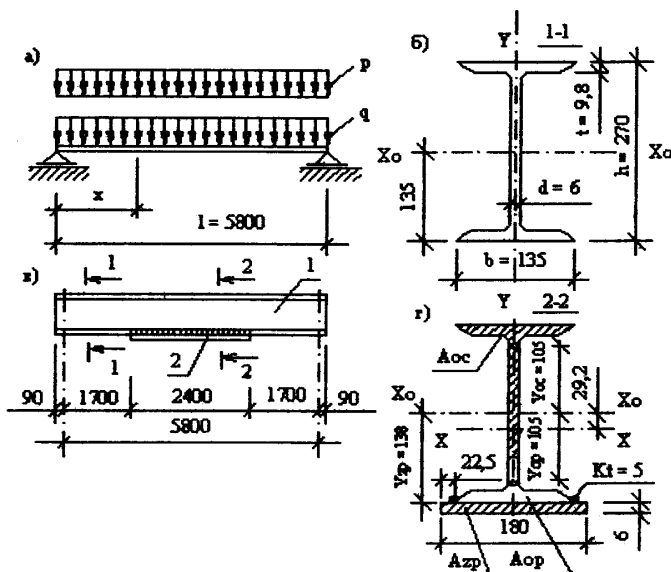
Розрахункова схема і підсилення балки: а – розрахункова схема балки; б – переріз балки до підсилення; в – розміщення елементів підсилення по довжині балки; г – переріз балки після підсилення; 1 – балка без підсилення; 2 – смуга підсилення
